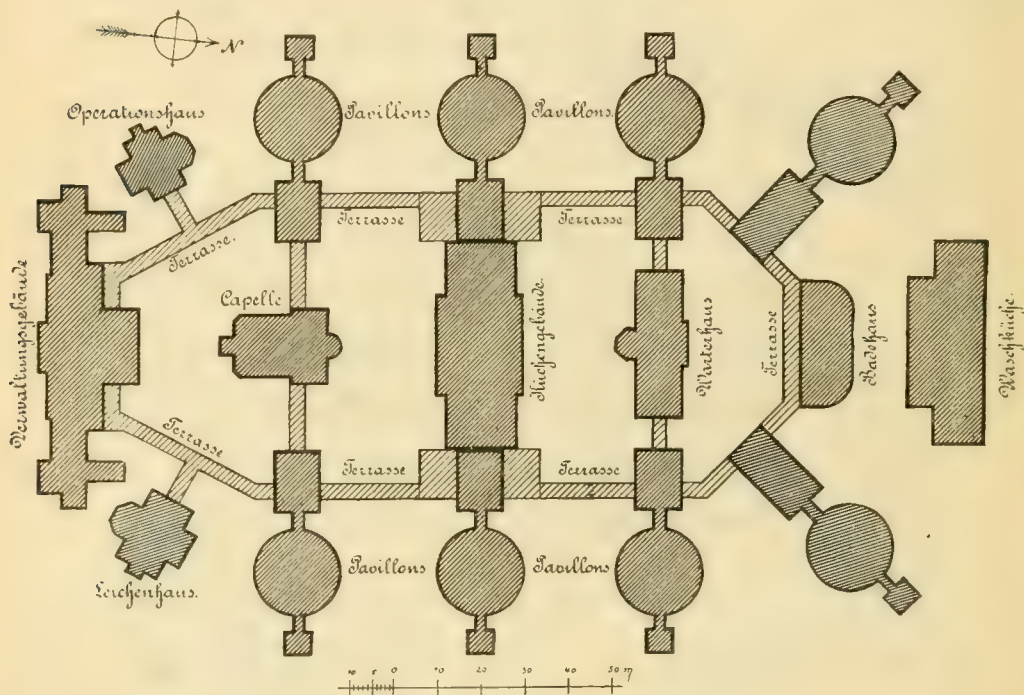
Civil-Hospital in Antwerpen. Lageplan.
